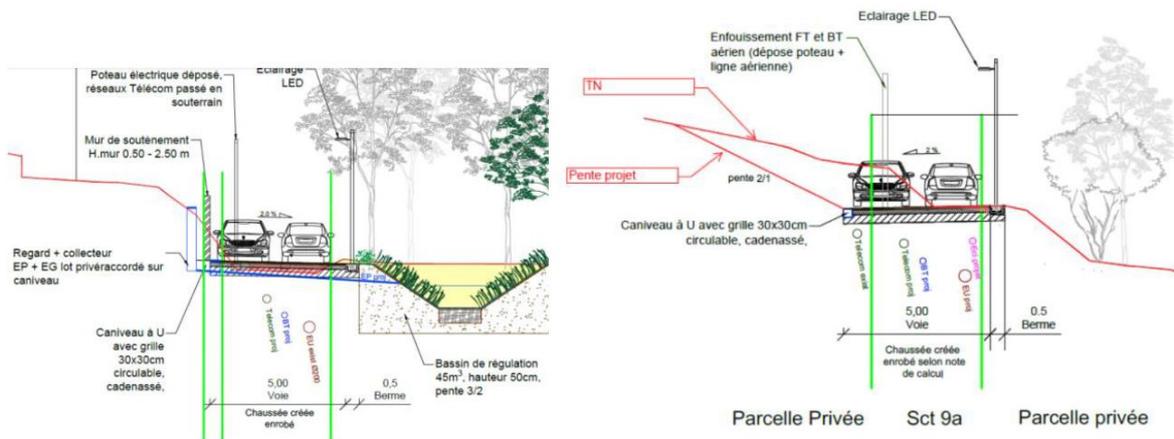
coupe de principe de la future voie des Maoupas et élargissement au niveau du bassin
